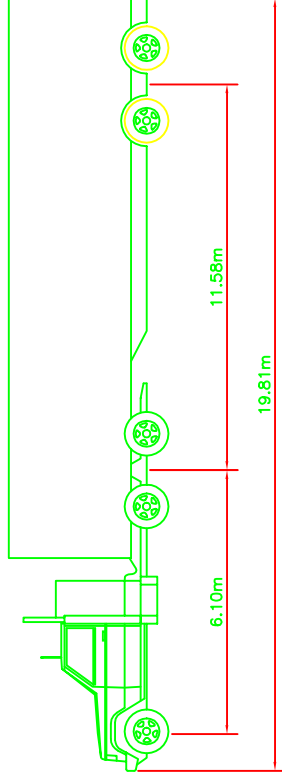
ANCHO PARA GIRO DE VEHICULOS PESADOS EN ROTONDAS NORMALES.
